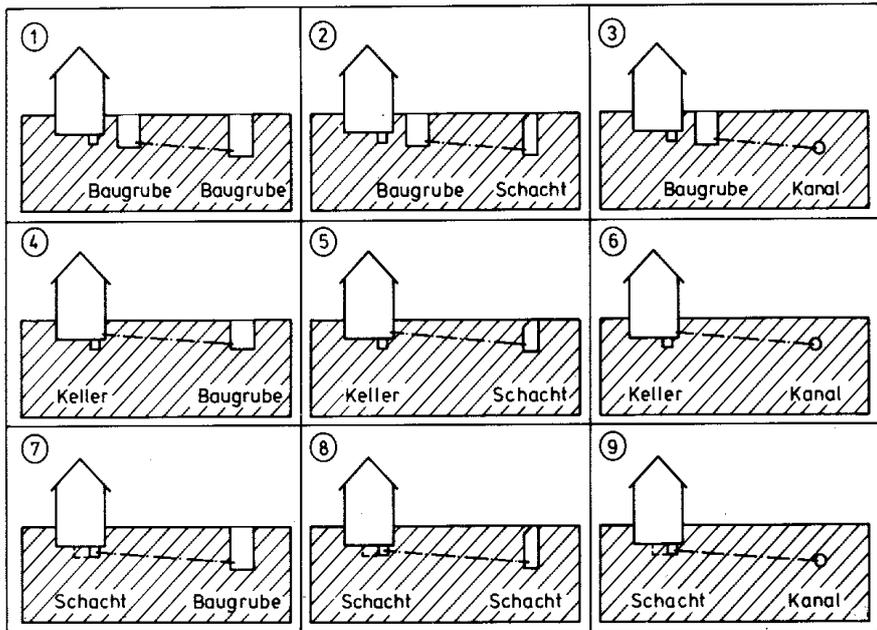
Übersicht ausführbarer Varianten zur Erstellung grabenloser Kanalhausanschlussleitungen
